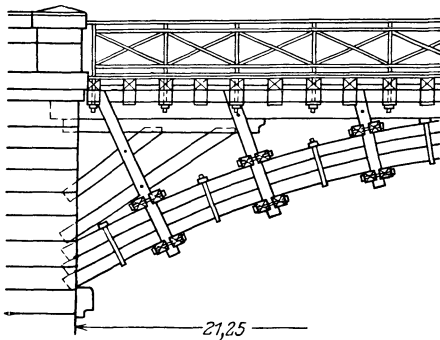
Brücke mit Hauptträgern aus gebogenen Balken.
